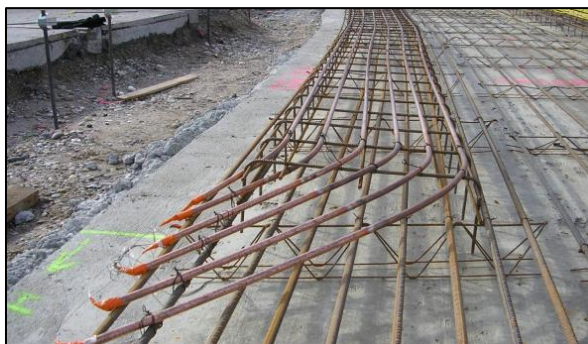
Exemple de réseau de chauffage sous dalle
